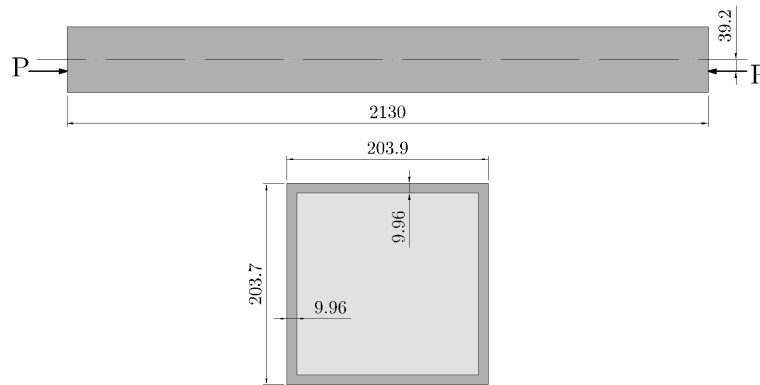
Geometria e carregamento da coluna SHC-1 (Bridge, 1976), medidas em mm.
